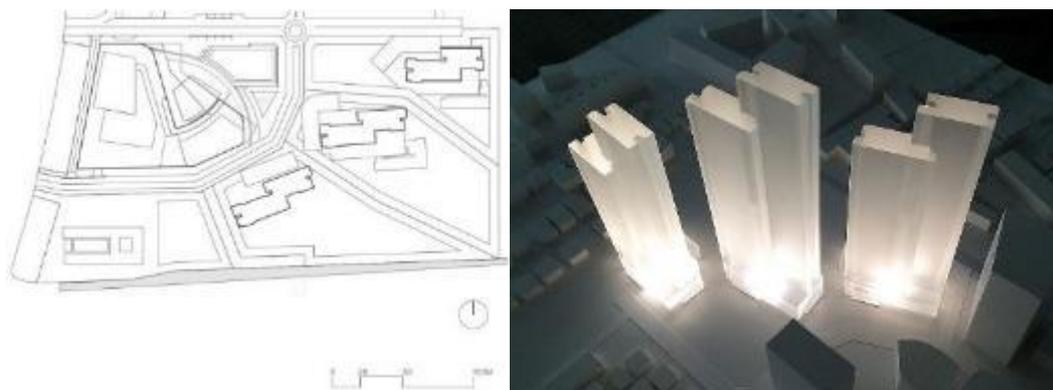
Whizdom 101 - Torres Habitacionais - Site Plan e Maquete
